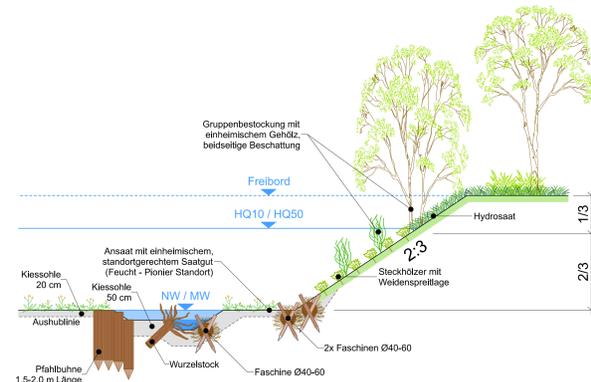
Normalprofil mit Böschung 2:3 aus Variante 1
